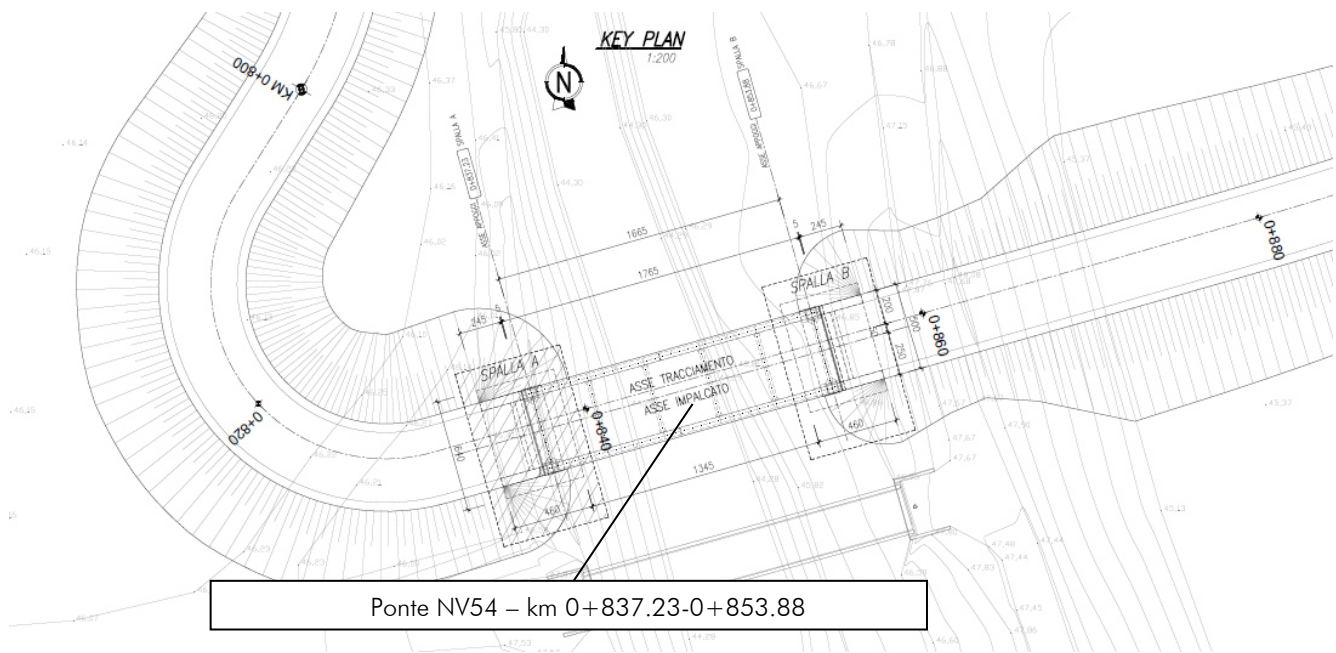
Stralcio planimetrico – Ubicazione Ponte pedonale NV54
